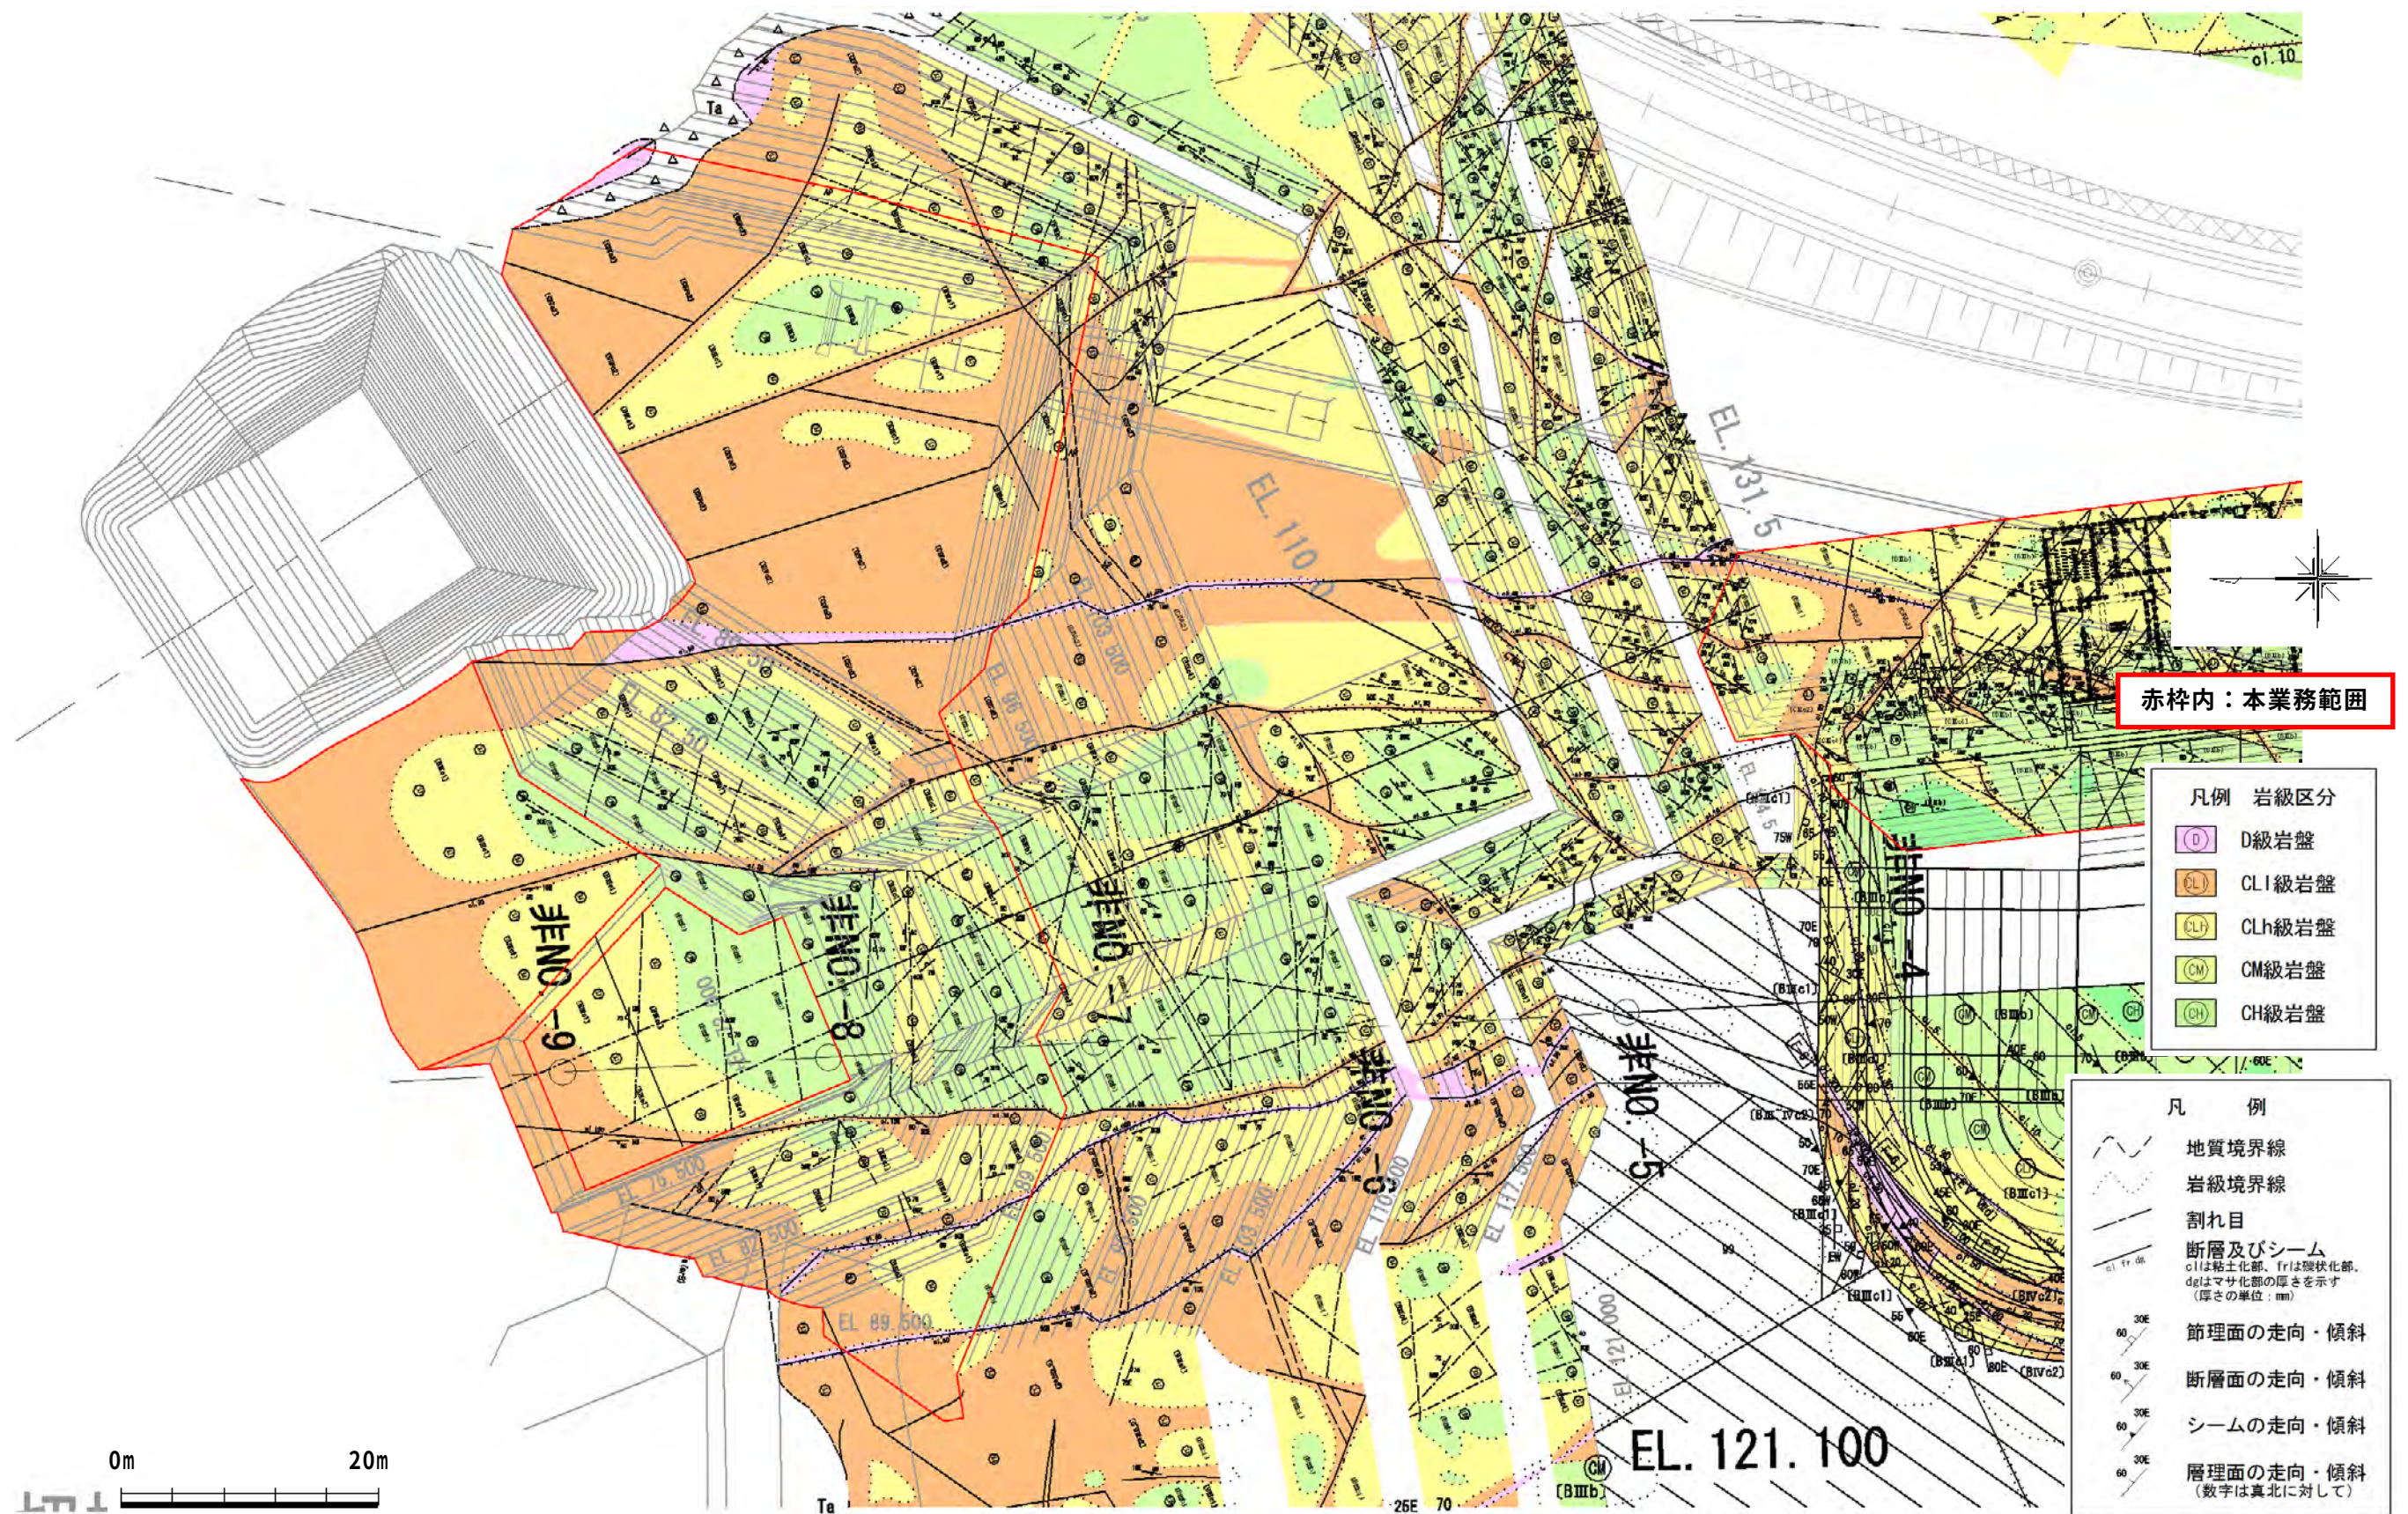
岩盤スケッチ平面図（岩級区分）
